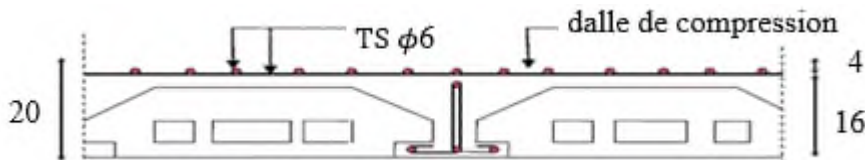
Schéma de ferrailage de la dalle de compression
